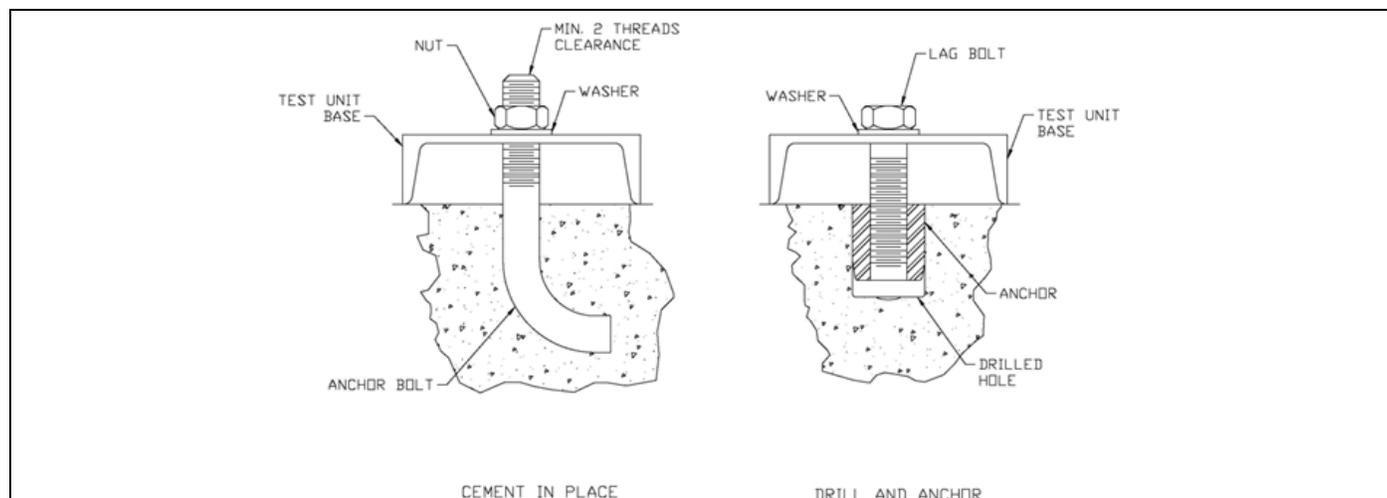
FIXATION DU BANC D'ESSAI
